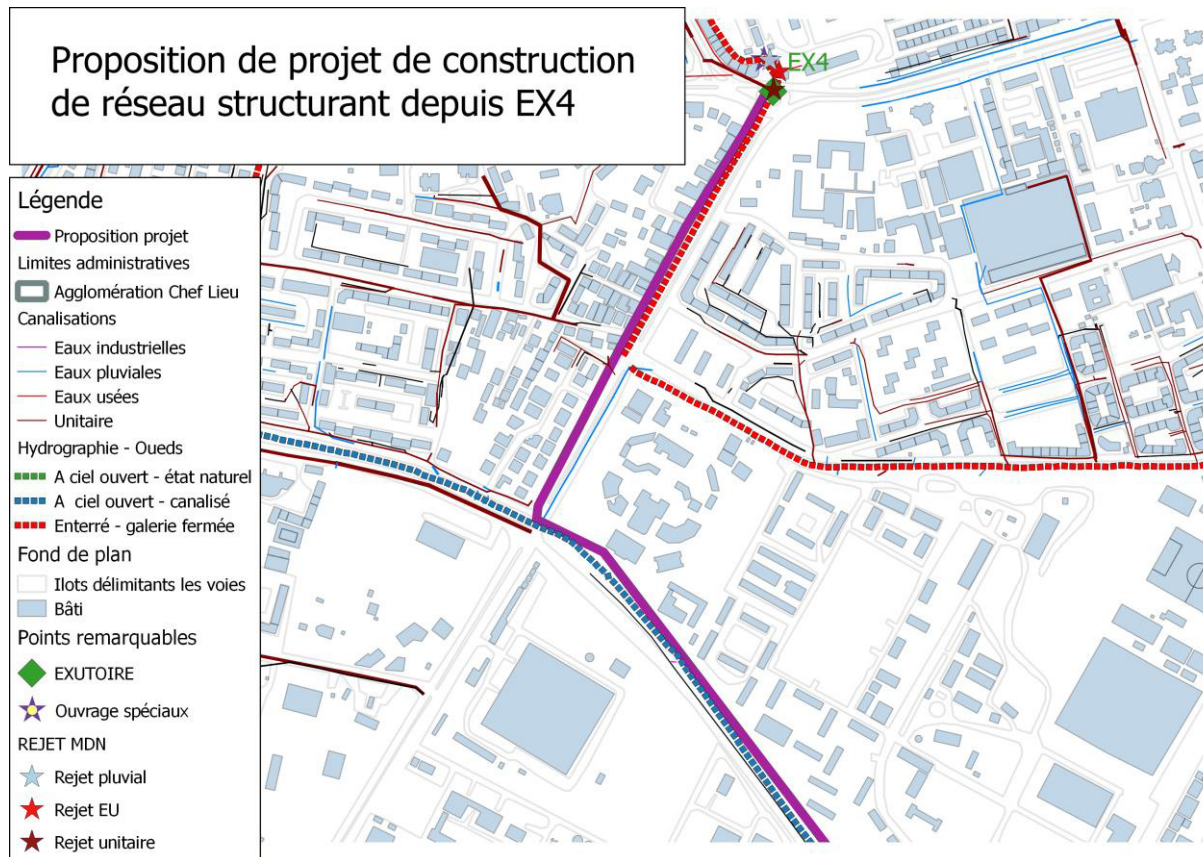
Proposition de projet de construction d'un réseau structurant depuis EX4
